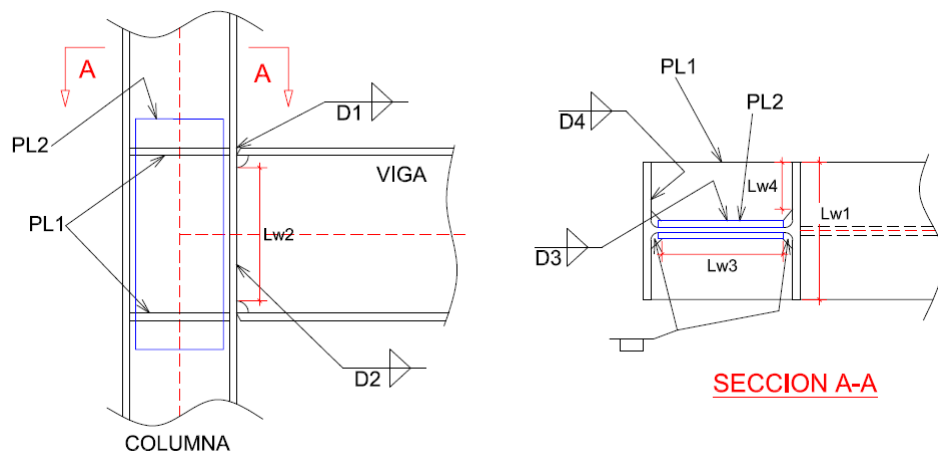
Esquema de conexión viga soldada a columna
